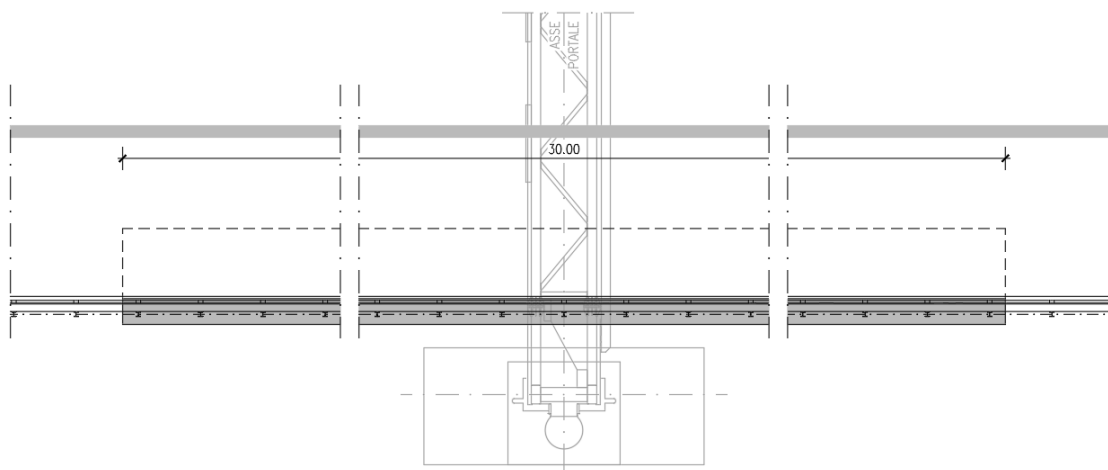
Schema planimetrico dell'intervento per la protezione dei portali esistenti
